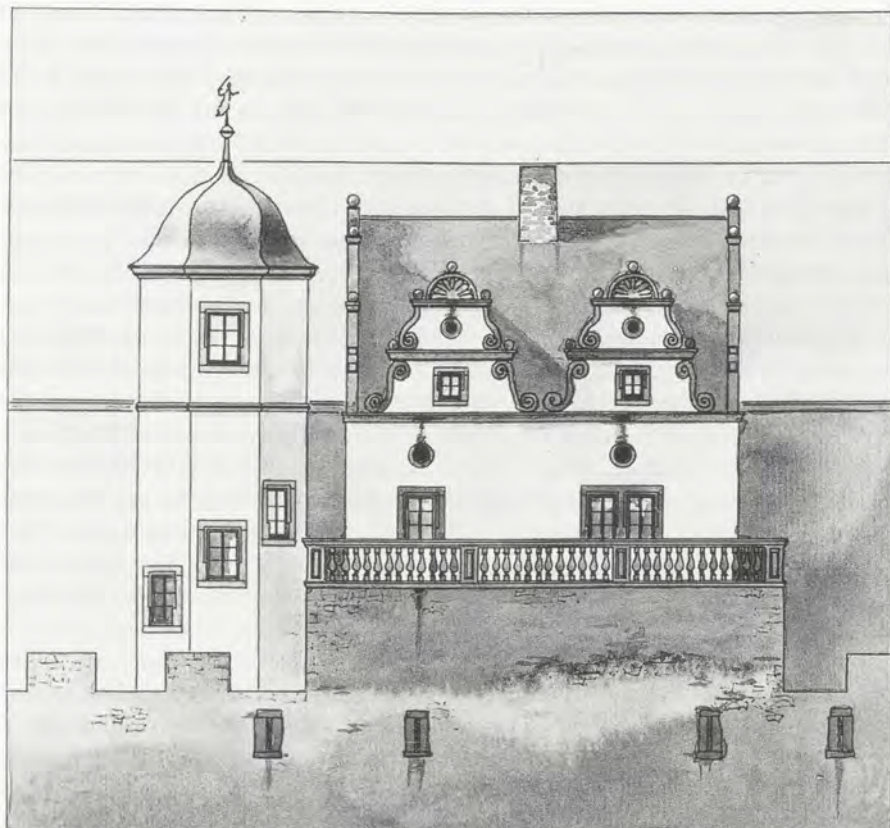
Seitenansicht des rekonstruierten Laboratoriums (Zeichnung: Walther-Gerd Fleck, Stuttgart)
